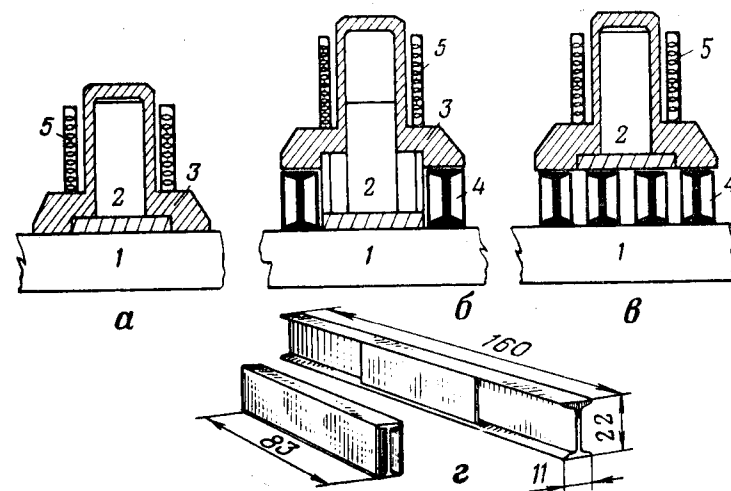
Схема подъема груза домкратом непрерывного действия: а — положение до выкачки; б — положение после выкачки; в — положение после подъема поршня; г — инвентарные балочки; 1 — продольные балочки; 2 — поршень с опорной плитой; 3 — корпус с лапами; 4 — поперечные балочки; 5 — возвратные пружины
